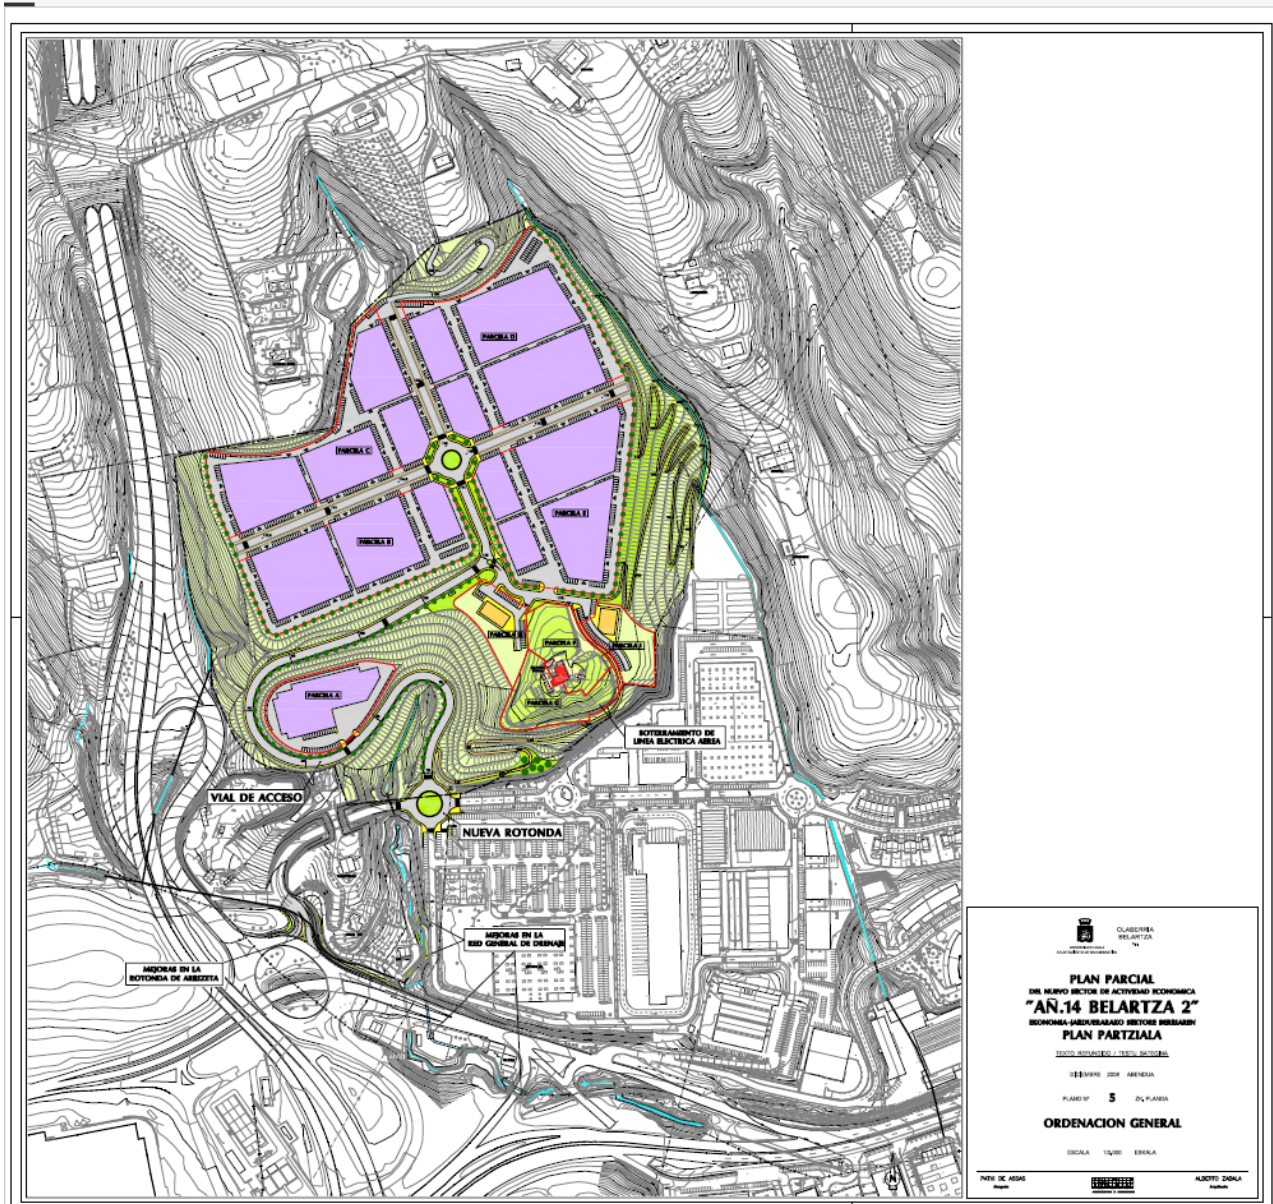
Plan Parcial del nuevo sector de actividad económica “AÑ.14 Belartza 2” (Diciembre de 2008). Plano 5. Ordenación General.
